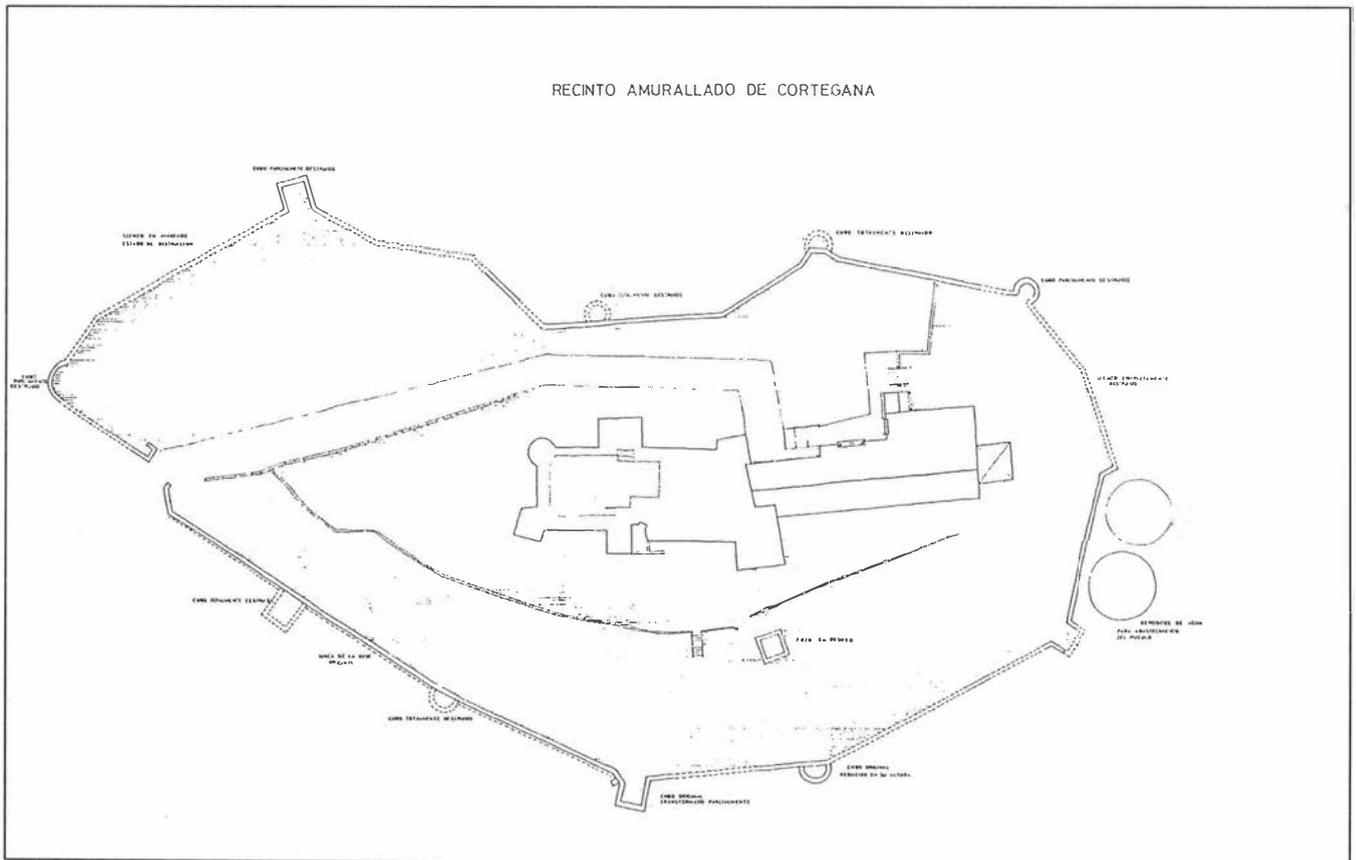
Plano de la restauración de E. Barceló. 1976.
